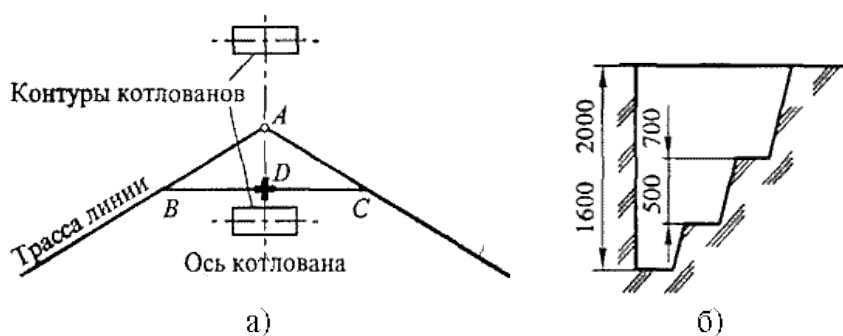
Разбивка котлована под угловую анкерную опору (а) и форма котлована, отрытого вручную (б).
